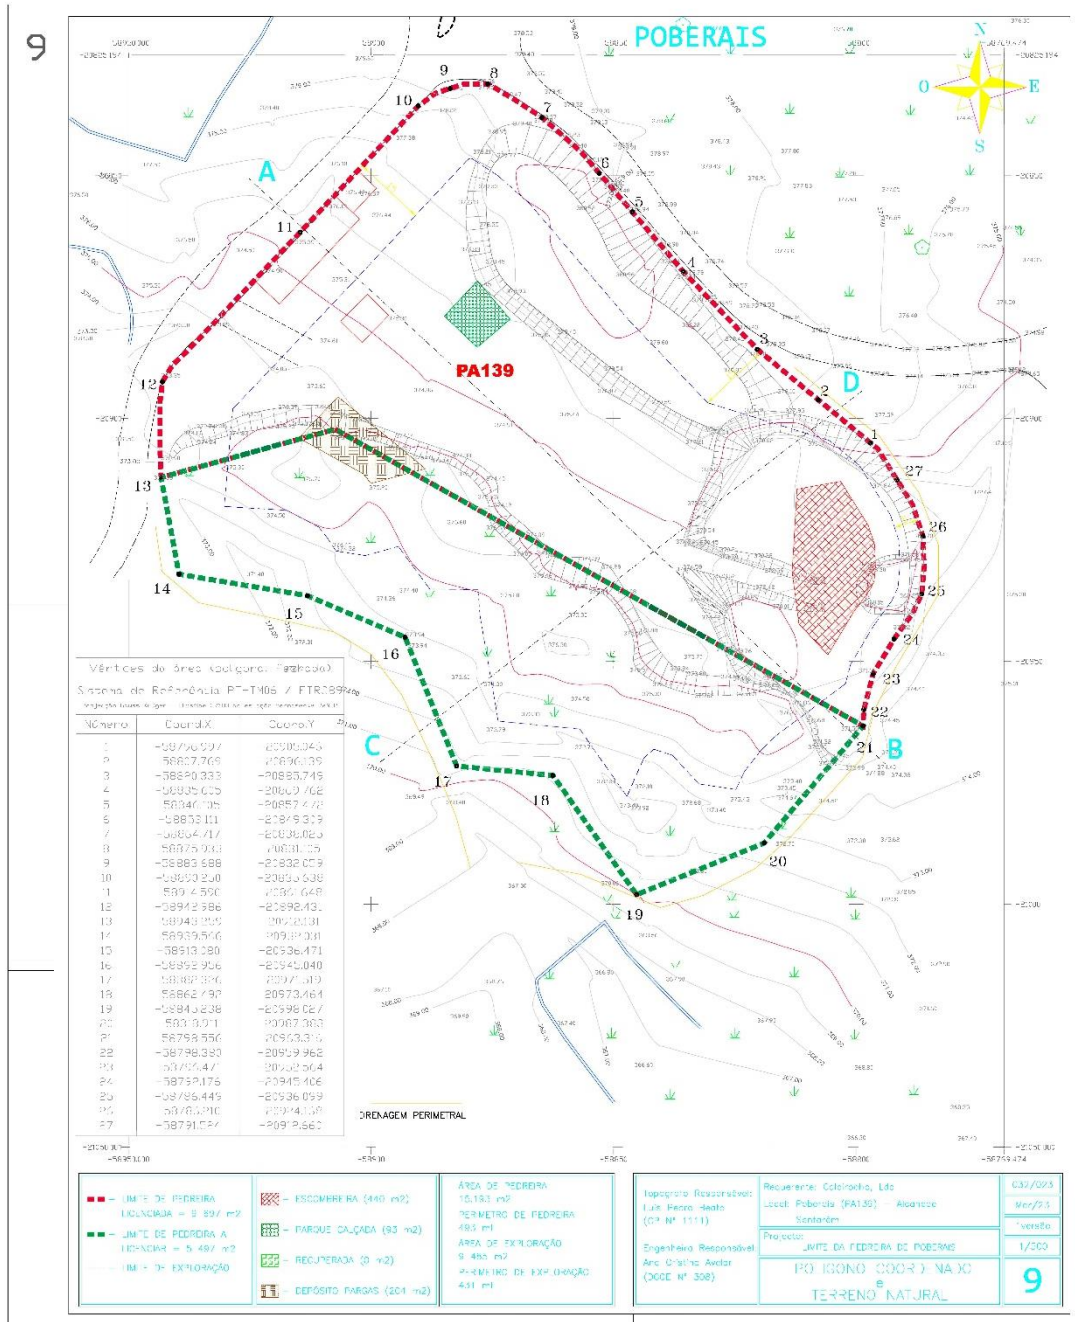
Planta de zonamento da pedreira “Poberais n.º 4”.
